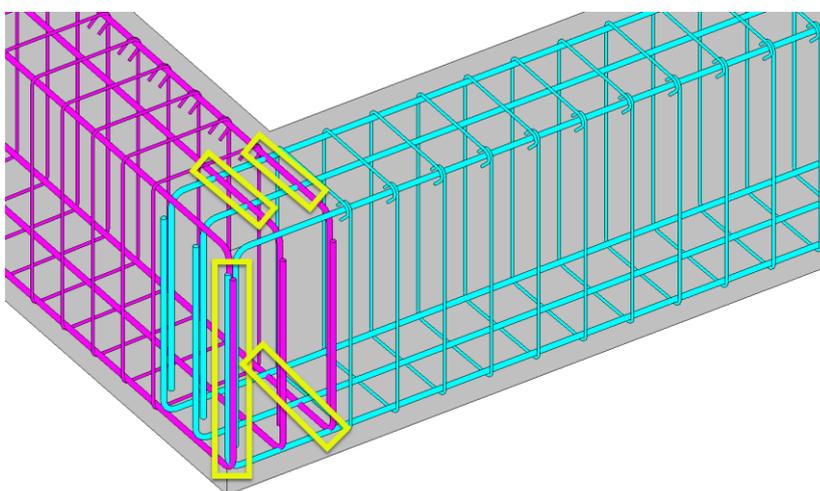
Situações típicas de sobreposição de armaduras modeladas em 3D.
